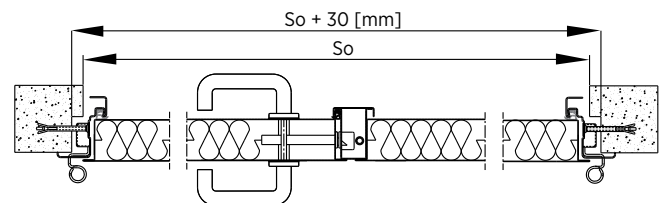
Montage zweiflügeliger Türen mit Eckzarge an der Mauer – Horizontalschnitt
